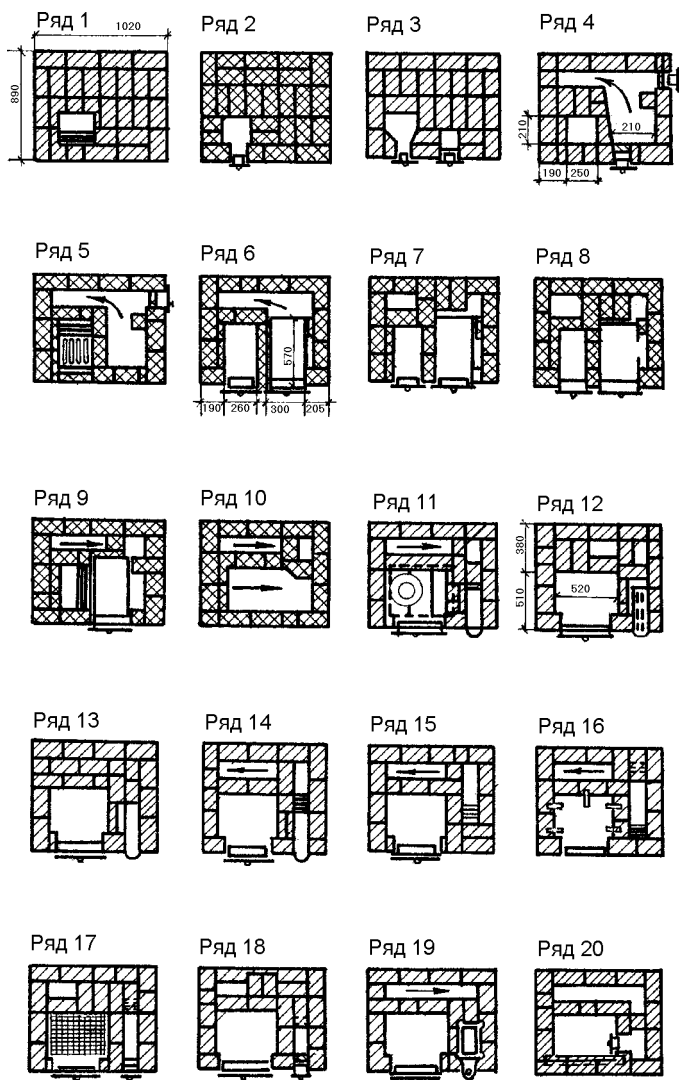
Кладка отопительно-варочной печи И.Ф. Волкова без камеры для выпечки хлеба
